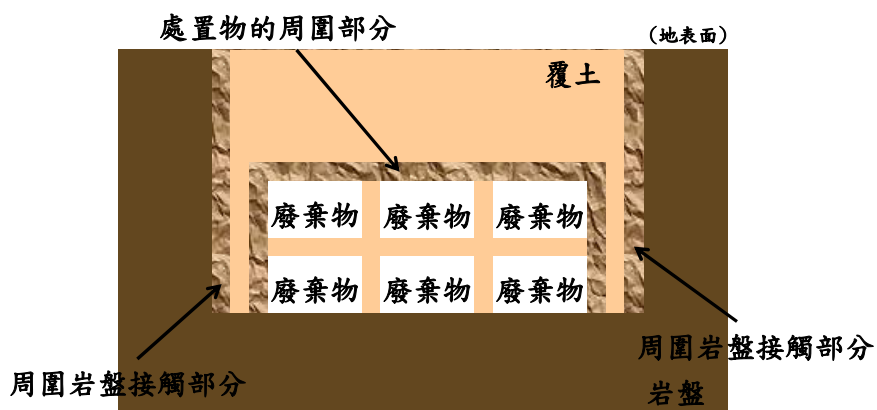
施工機械及施工方法的選擇所需留意的施工區域(覆土)
